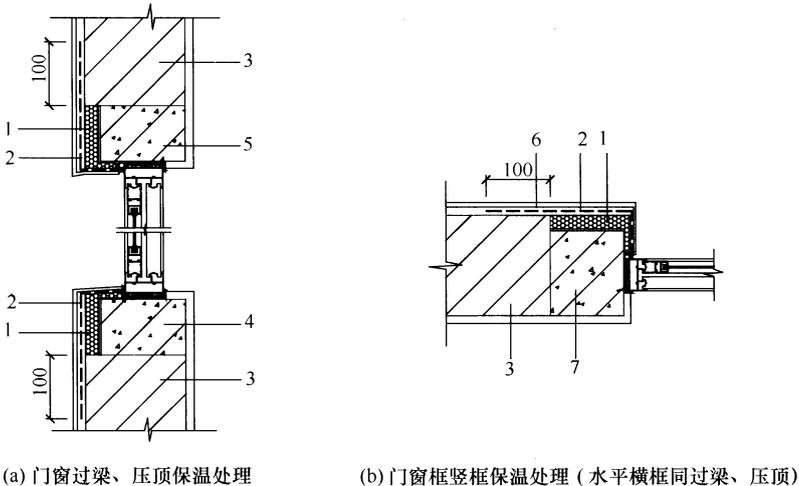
压顶、过梁及钢筋混凝土框的保温处理
